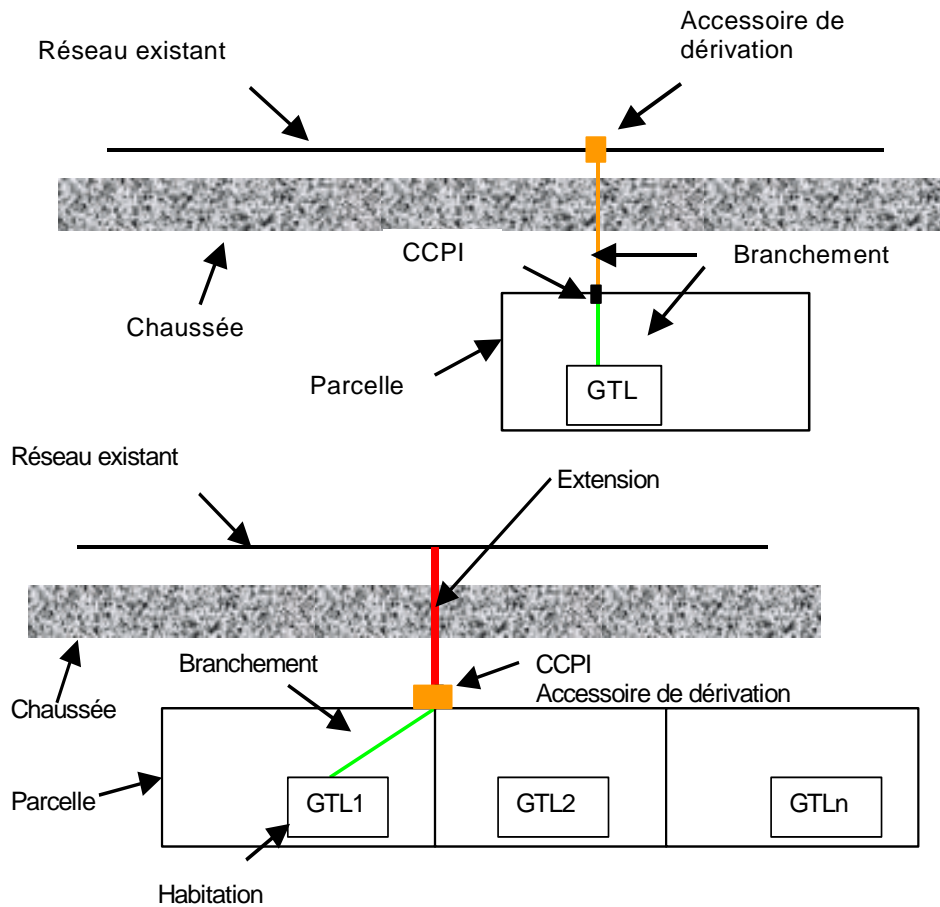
Raccordement individuel BT ≤ 36 kVA avec traversée de chaussée
